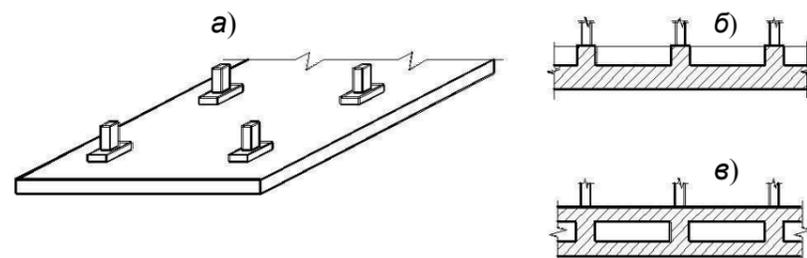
Сплошные фундаменты под колонны; а - плитный безбалочный; б – плитно-балочный; в – коробчатый.
